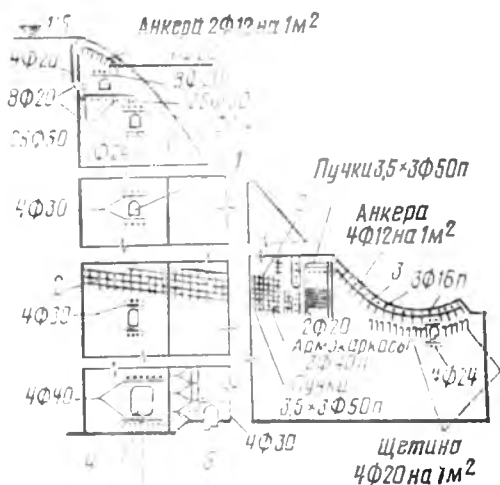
Армирование водосливной секции плотины Братской ГЭС:
